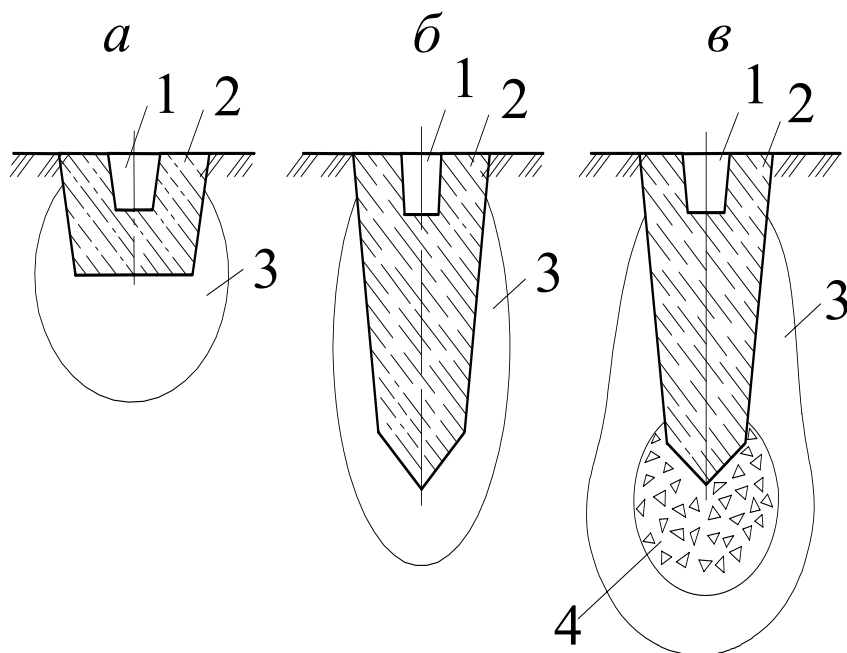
Схемы устройства вытрамбованного котлована под отдельно стоящий фундамент: а – с плоской подошвой; б – с заостренной подошвой обычного типа; в – с уширенным основанием; 1 – стакан для установки колонны; 2 – фундамент; 3 – зона уплотнения; 4 – втрамбованный жесткий материал
